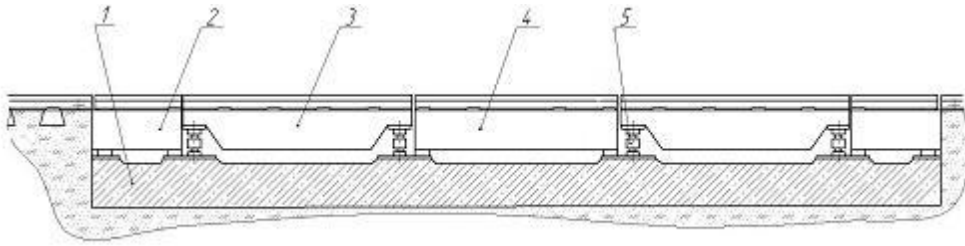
Весы ВЖД без капитального фундамента, на закладной раме.
